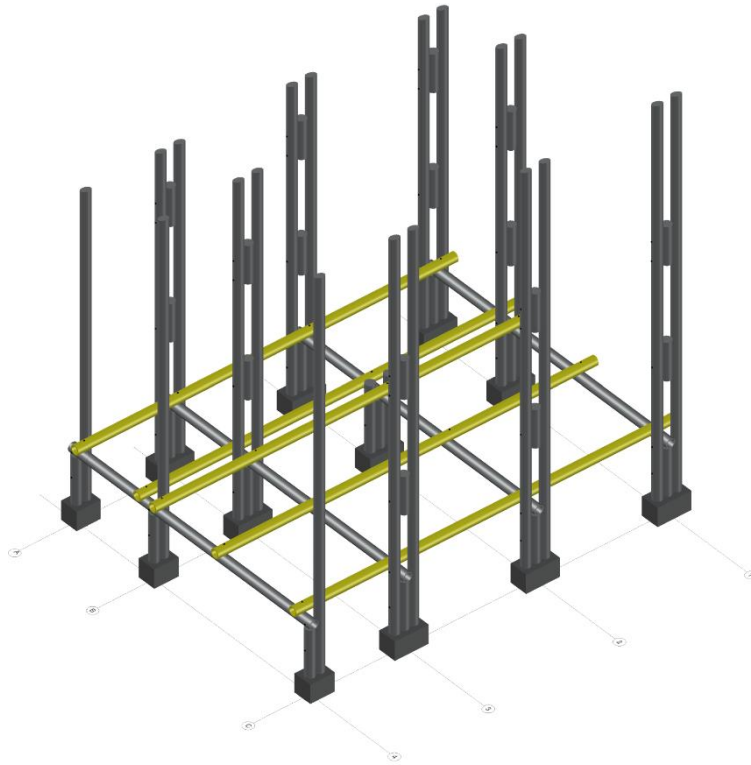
Vigas secundarias de entrepiso de la vivienda de emergencia. Fuente: Elaboración Propia
